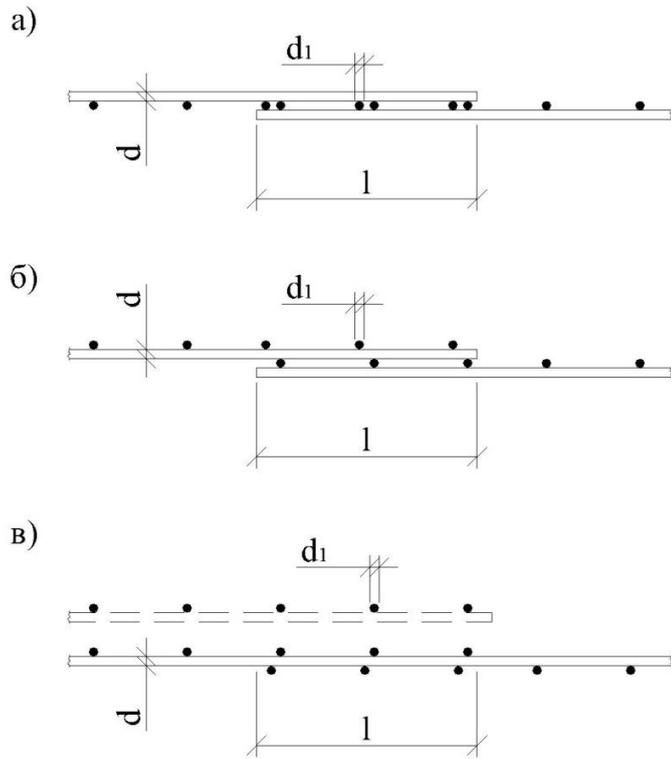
Стыки сварных сеток «внахлестку» (без сварки) в направлении рабочей арматуры, выполненной из гладких стержней
